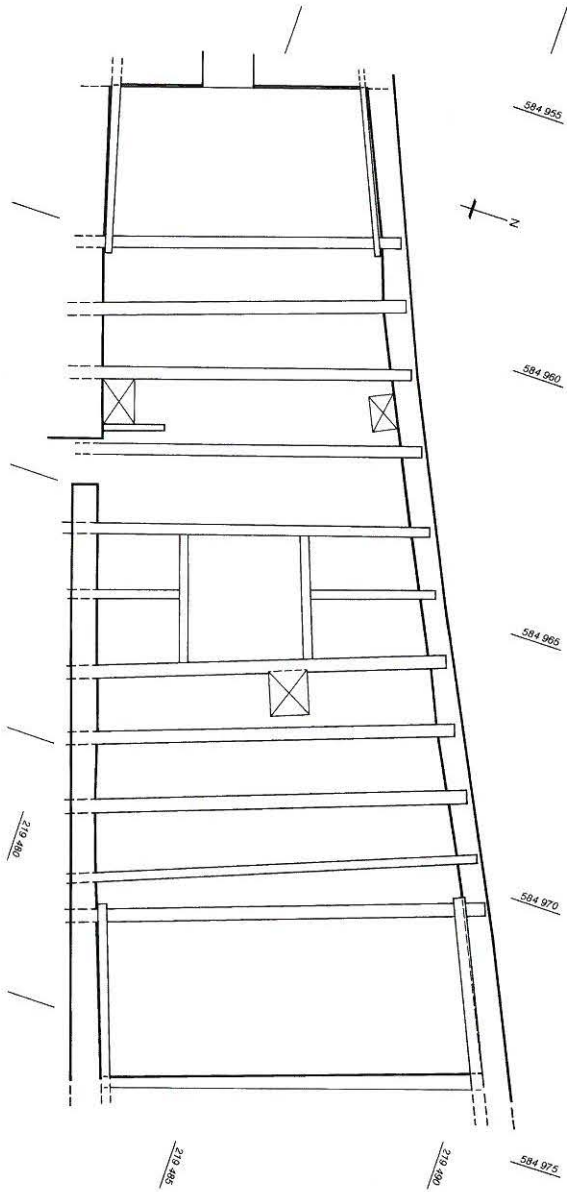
Nidau, Hauptstrasse 17. Dachgeschoss. Grundriss. M. 1:150.
